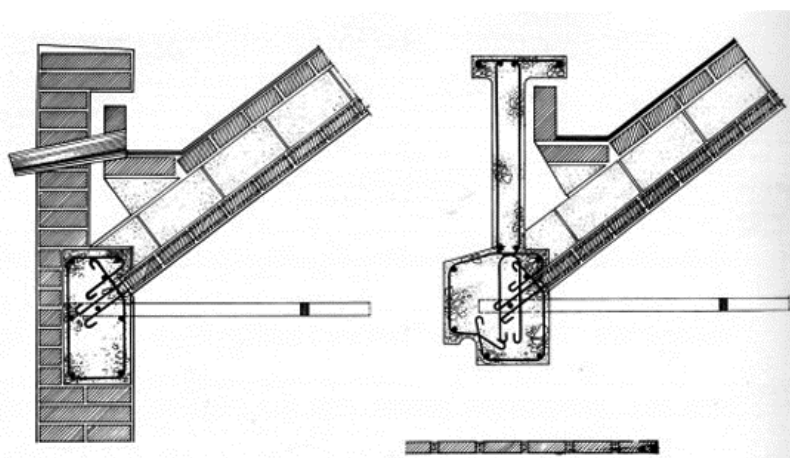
Detalhe construtivo da câmara de ar da abóbada e da união da abóbada com a viga.
